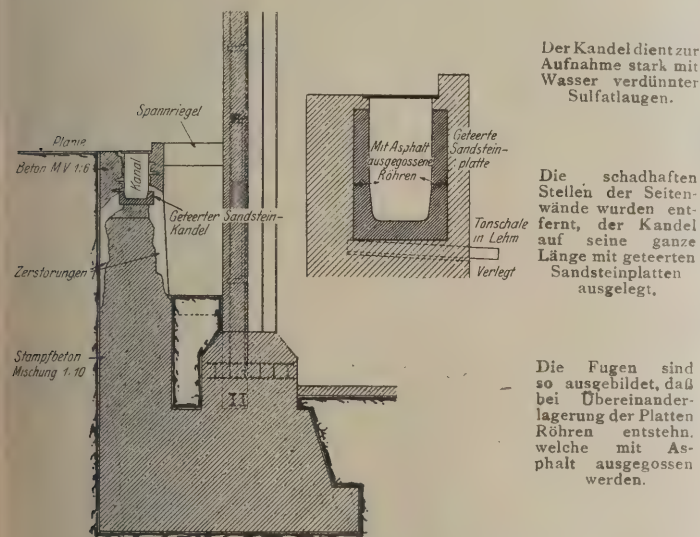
Baukandel zur Abführung von Sulfatlaugen.
